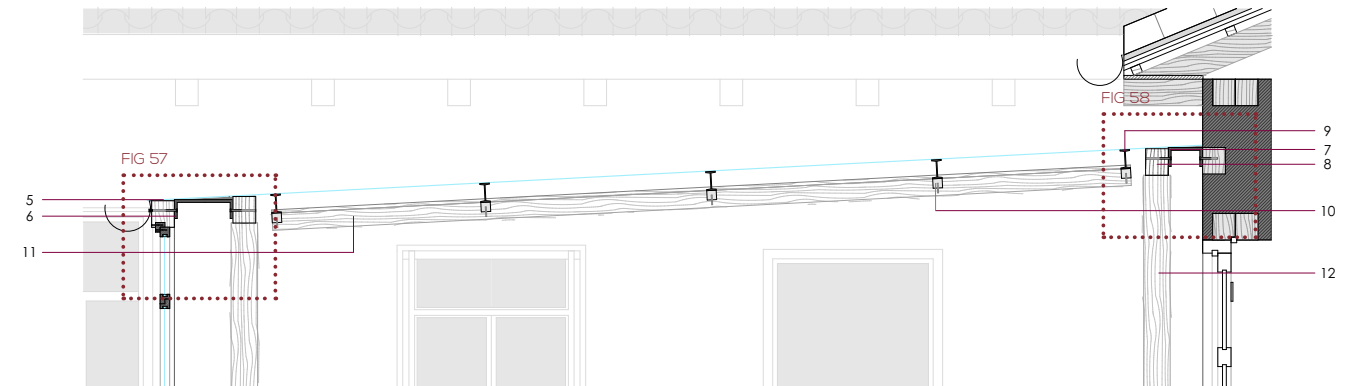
Detalle constructivo 25 | Propuesta, cubierta sala.
